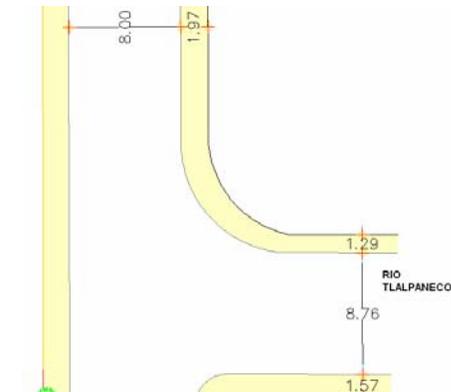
Cerrada Río Tlalpaneco. Arroyo vehicular 8.76m, banquetas arriba 1.29m abajo 1.57m. Arroyo Vehicular Principal 8.00m.
